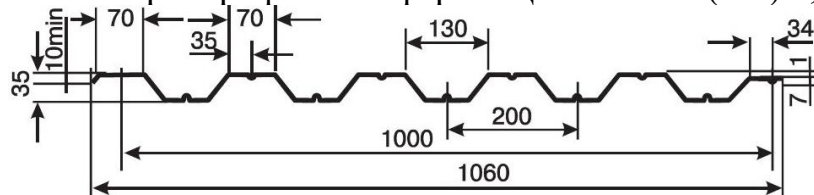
Размеры профиля профнастила НС35-1000-0,7
